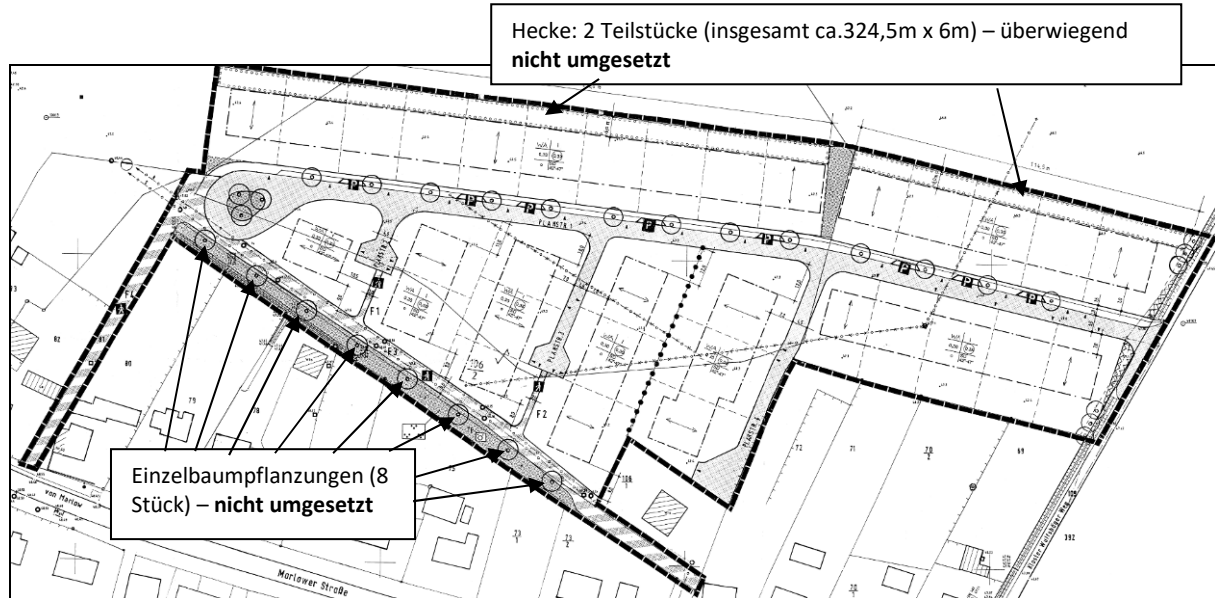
Alter B-Plan mit Darstellung geplanter Pflanzmaßnahmen im Ergänzungsbereich der 1. Änderung
